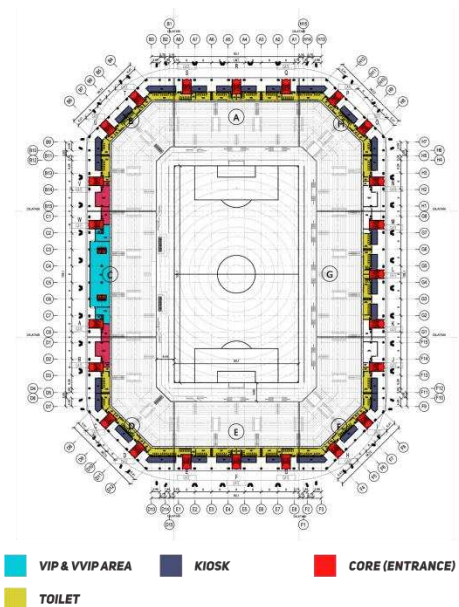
Denah Lantai 2 PSPS Home Stadium
